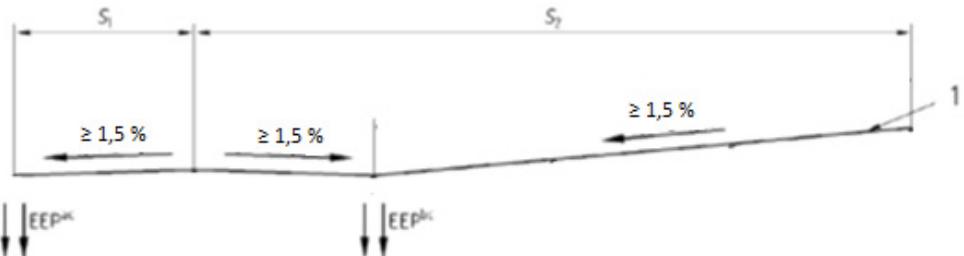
Panneaux structuraux perpendiculaires par rapport à la noue
